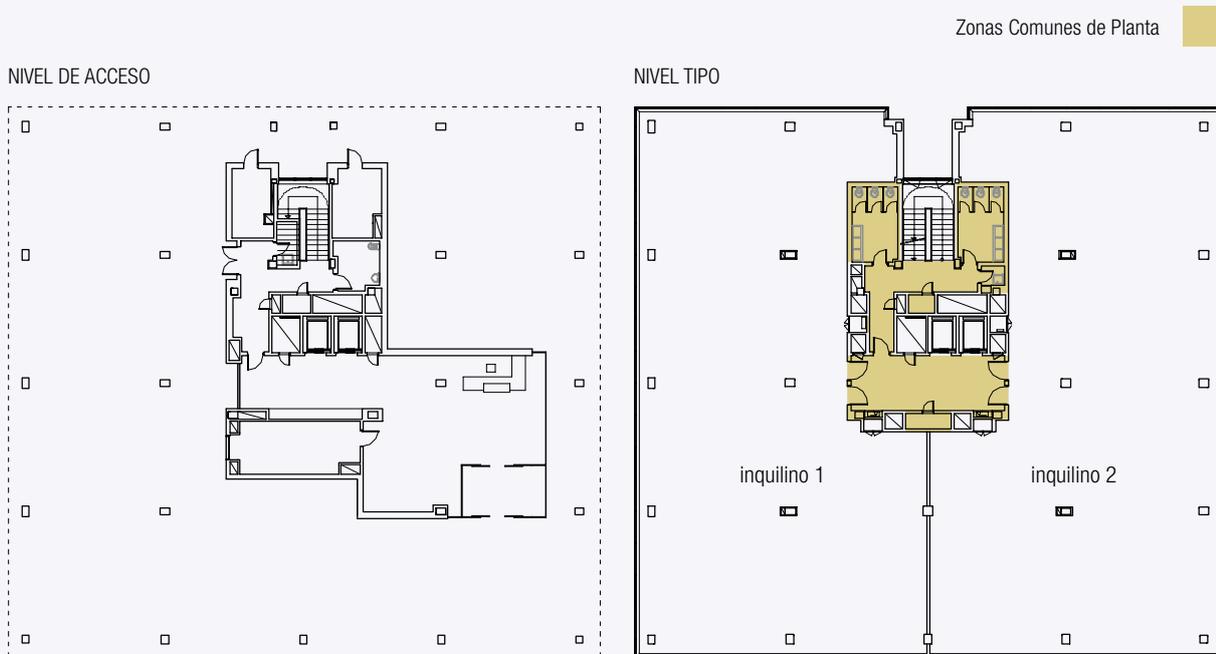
Ejemplo de Zonas Comunes de Planta (ZCP) en nivel de acceso y nivel tipo
